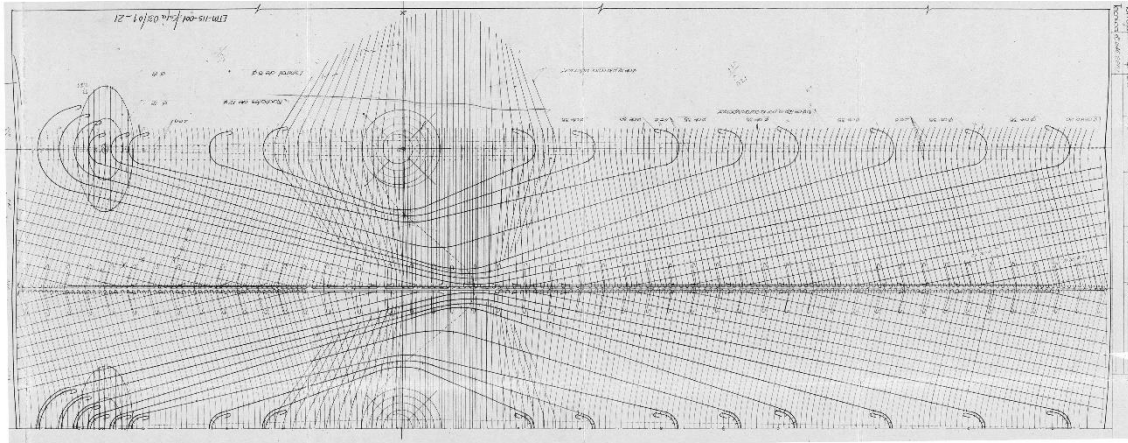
Detalle de la armadura de la cubierta. (Fuente: Plano nº 246.228 del AET)
